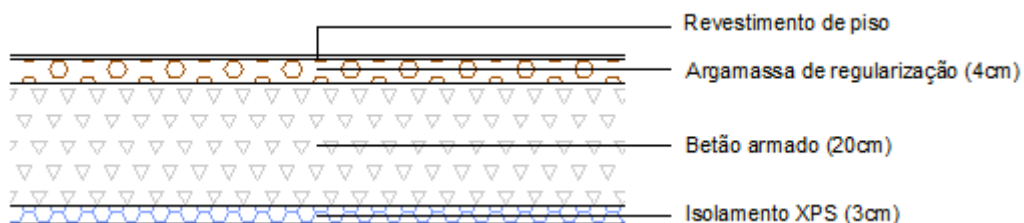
Pormenor construtivo de pavimentos sobre o exterior
